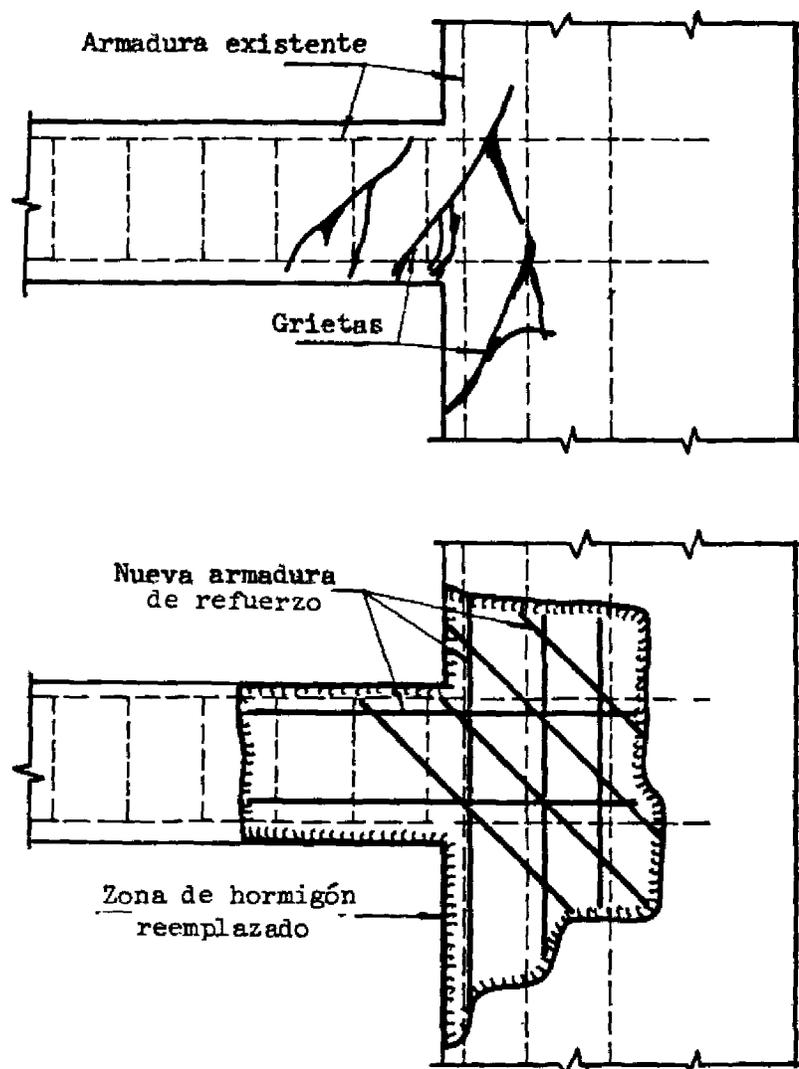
Caso V-4. REPARACION DE UNA VIGA EN SU UNION CON PILAR O MURO (uso de hormigón inyectado y refuerzo de armaduras)
